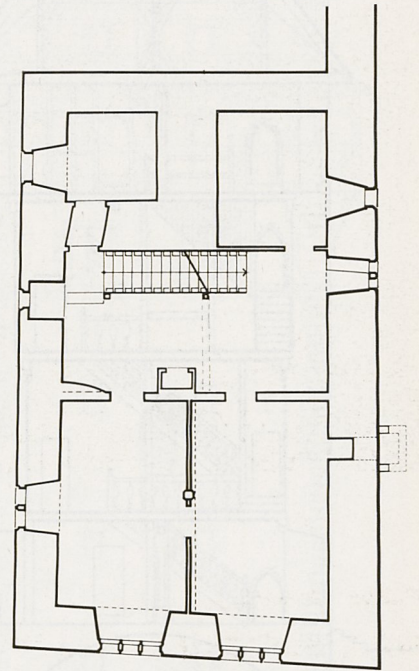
Grundriß vom 1. Obergeschoß M 1:200, Zustand 1971
